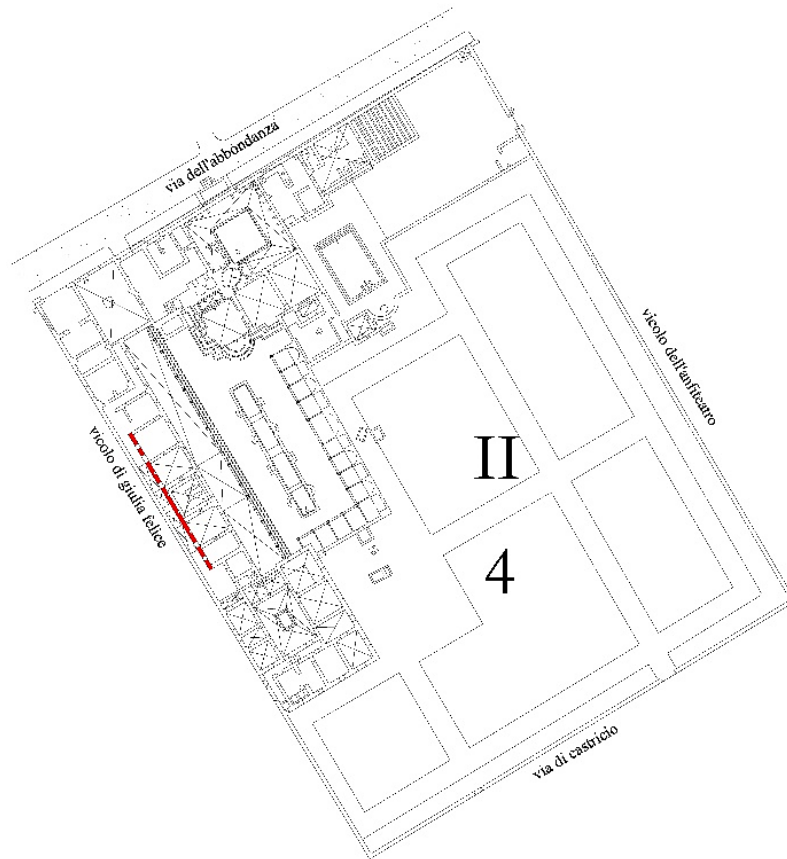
Planta Villa di Giulia Felice y el muro perimetral investigado (en rojo).
